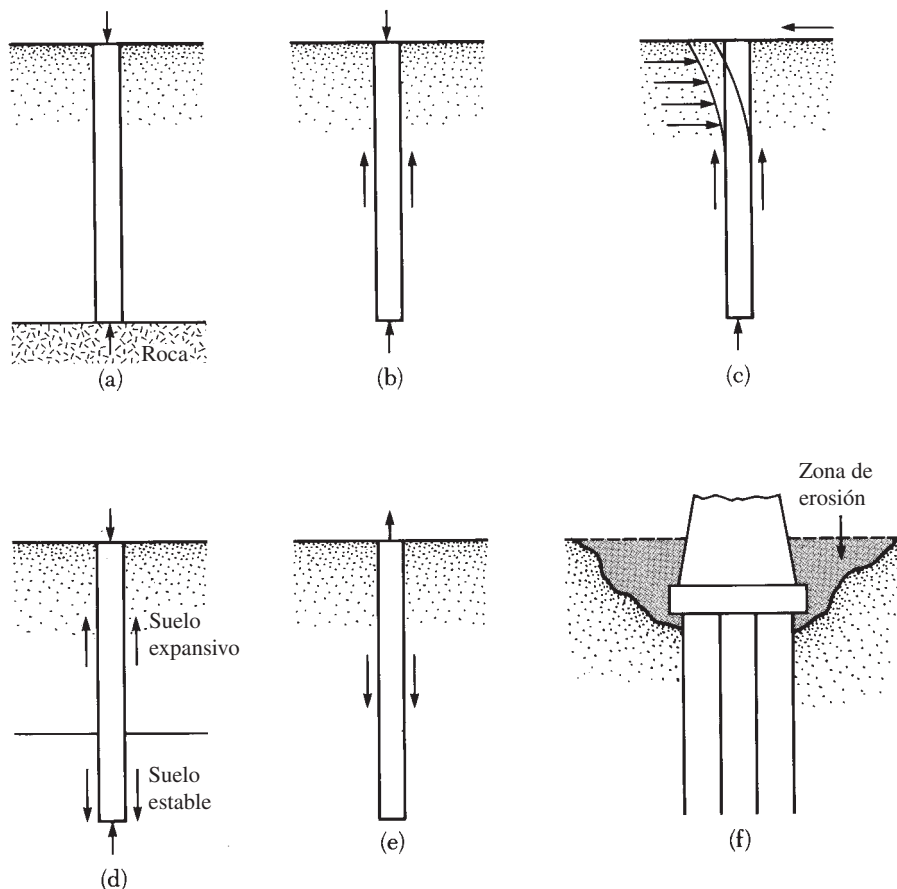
Condiciones para el uso de pilotes de cimentación
